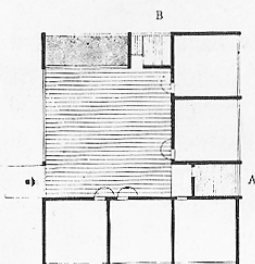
Schema planimetrico dei gruppi 1 e 2.
